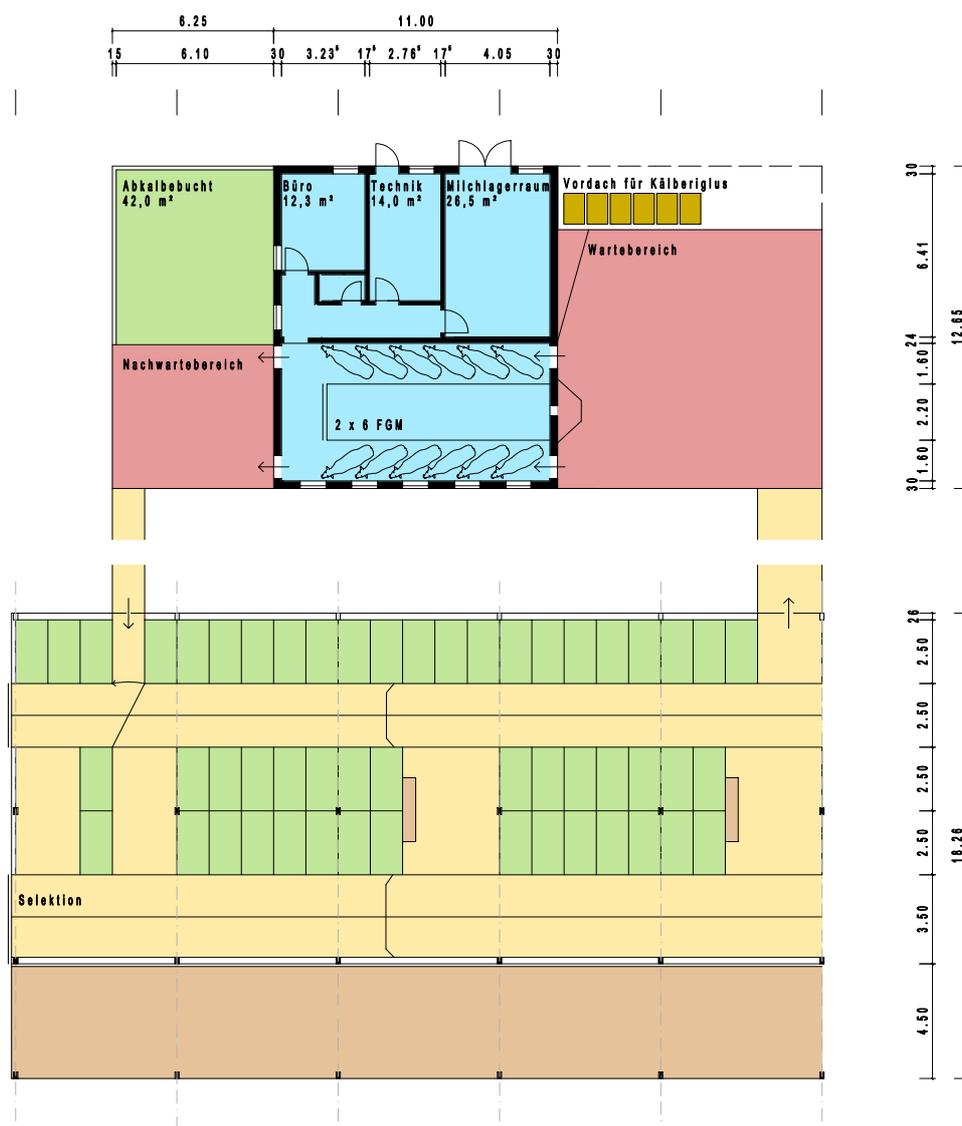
Grundriss für ein separates Melkhaus mit 2 x 6er Fischgrätenmelkstand, Wart- und Nachwartebereich und separatem Selektions- und Abkalbebereich
